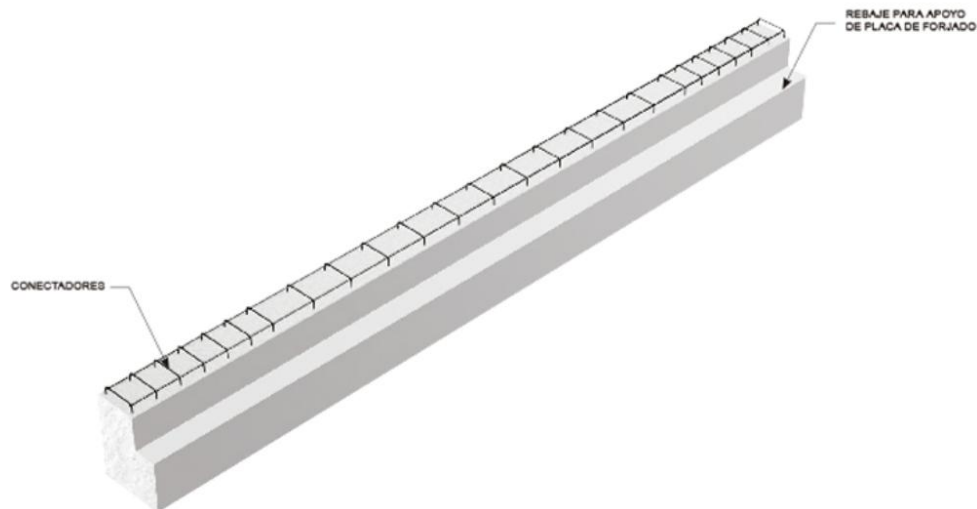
Detalle de viga de carga longitudinal VCL para soporte de cubierta
